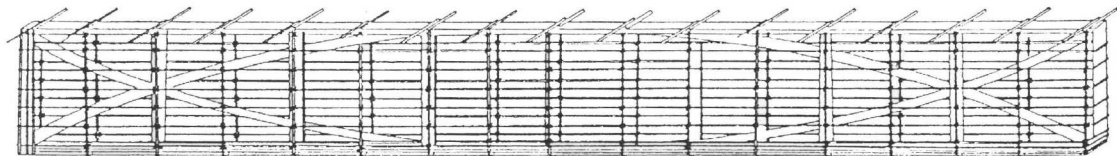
schéma de ferrailage de la poutre brevetée par Joseph MONIER en 1878
